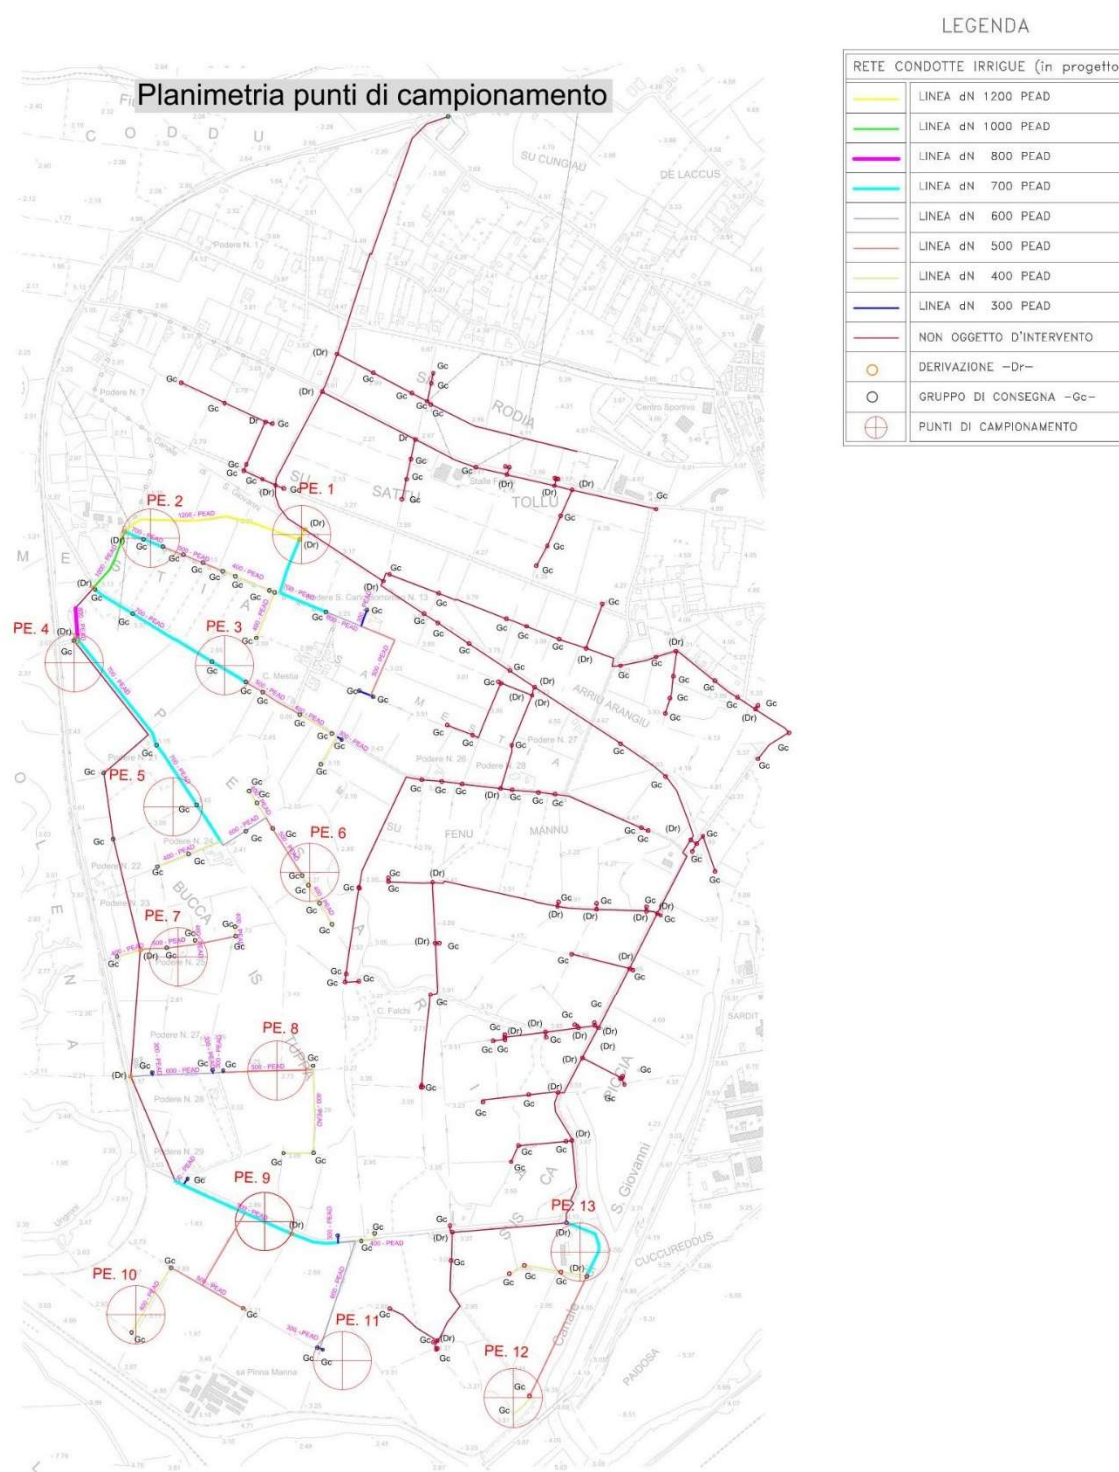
Planimetria con la localizzazione dei punti di campionamento
